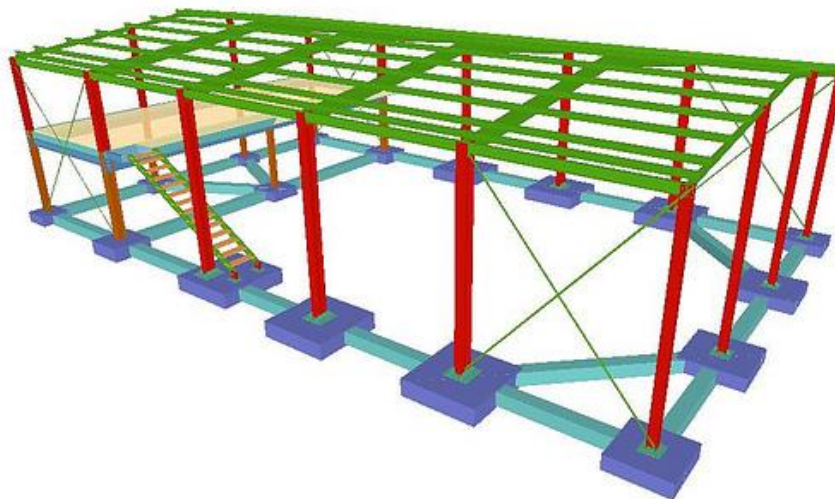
diagrama tipo isométrico de estructura con cimentación de zapatas y traveses de liga, fuente: http://farm5.static.flickr.com/4044/4504651998_1f645c86fa.jpg
